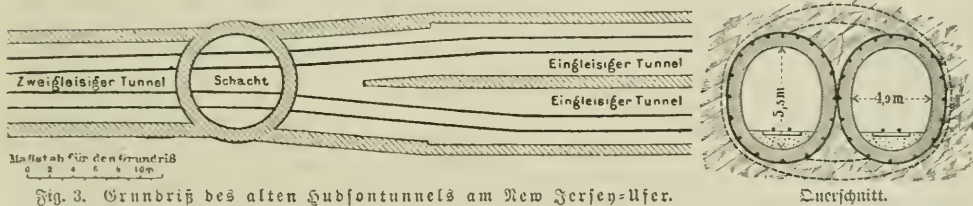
Grundriß des alten Hudsonstunnels am New Jersey-Ufer.
